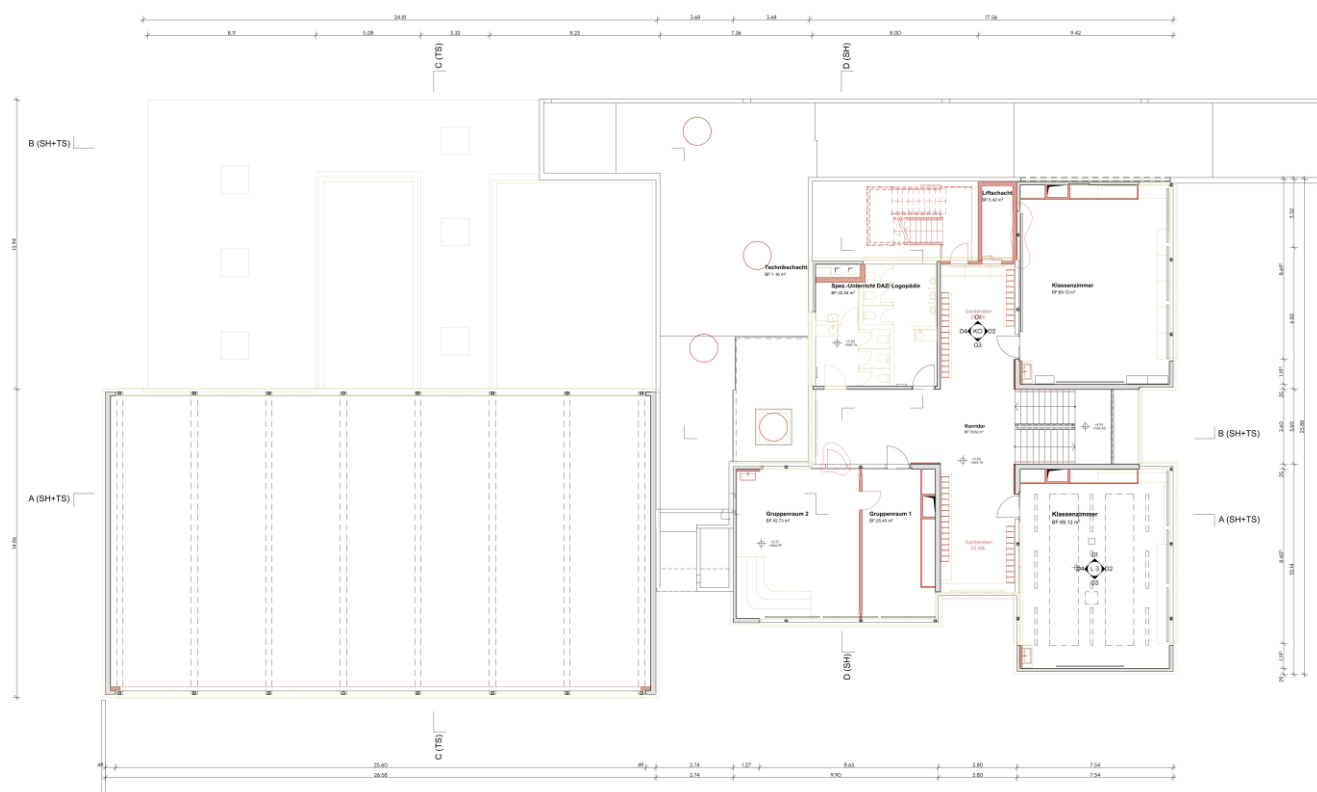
Grundriss 1. Obergeschoss, Gebäude 1 (links) und 2 (rechts)
